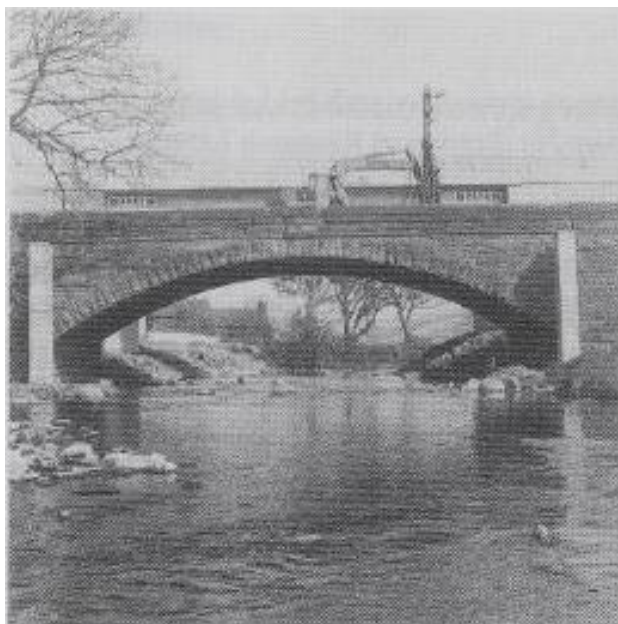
Ponte em arco de alvenaria de Bridgmill. Figura retirada de (PAGE 1995).
